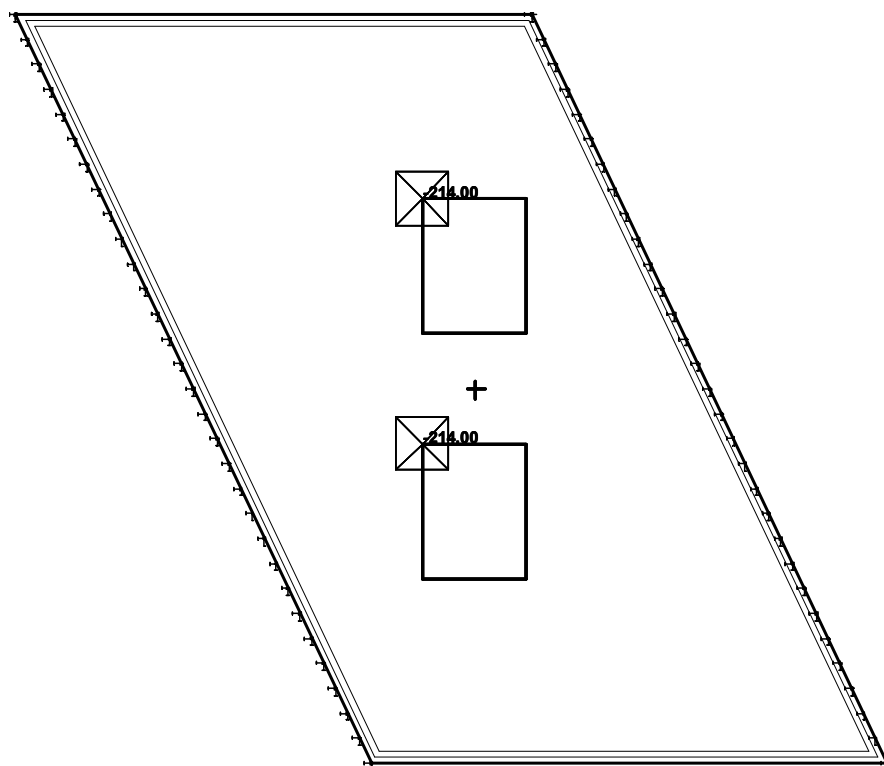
Schéma zatížení konstrukce dopravou, vč. roznášení kolových tlaků 900/150, poloha pro stanovení maxima na okraji konstrukce
